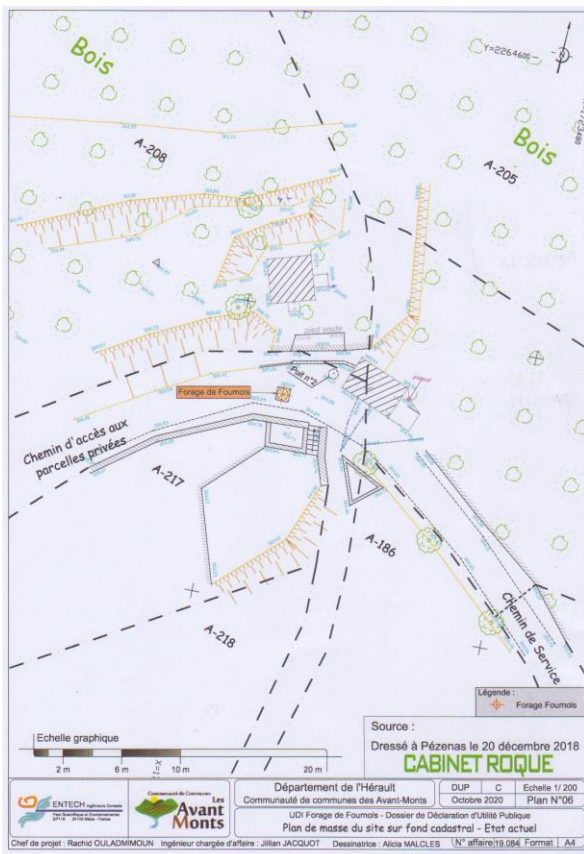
Plan de masse du site sur fond cadastral [Plan N°6 de la Pièce N°6 : Livret des documents graphique du dossier d'enquête publique]
